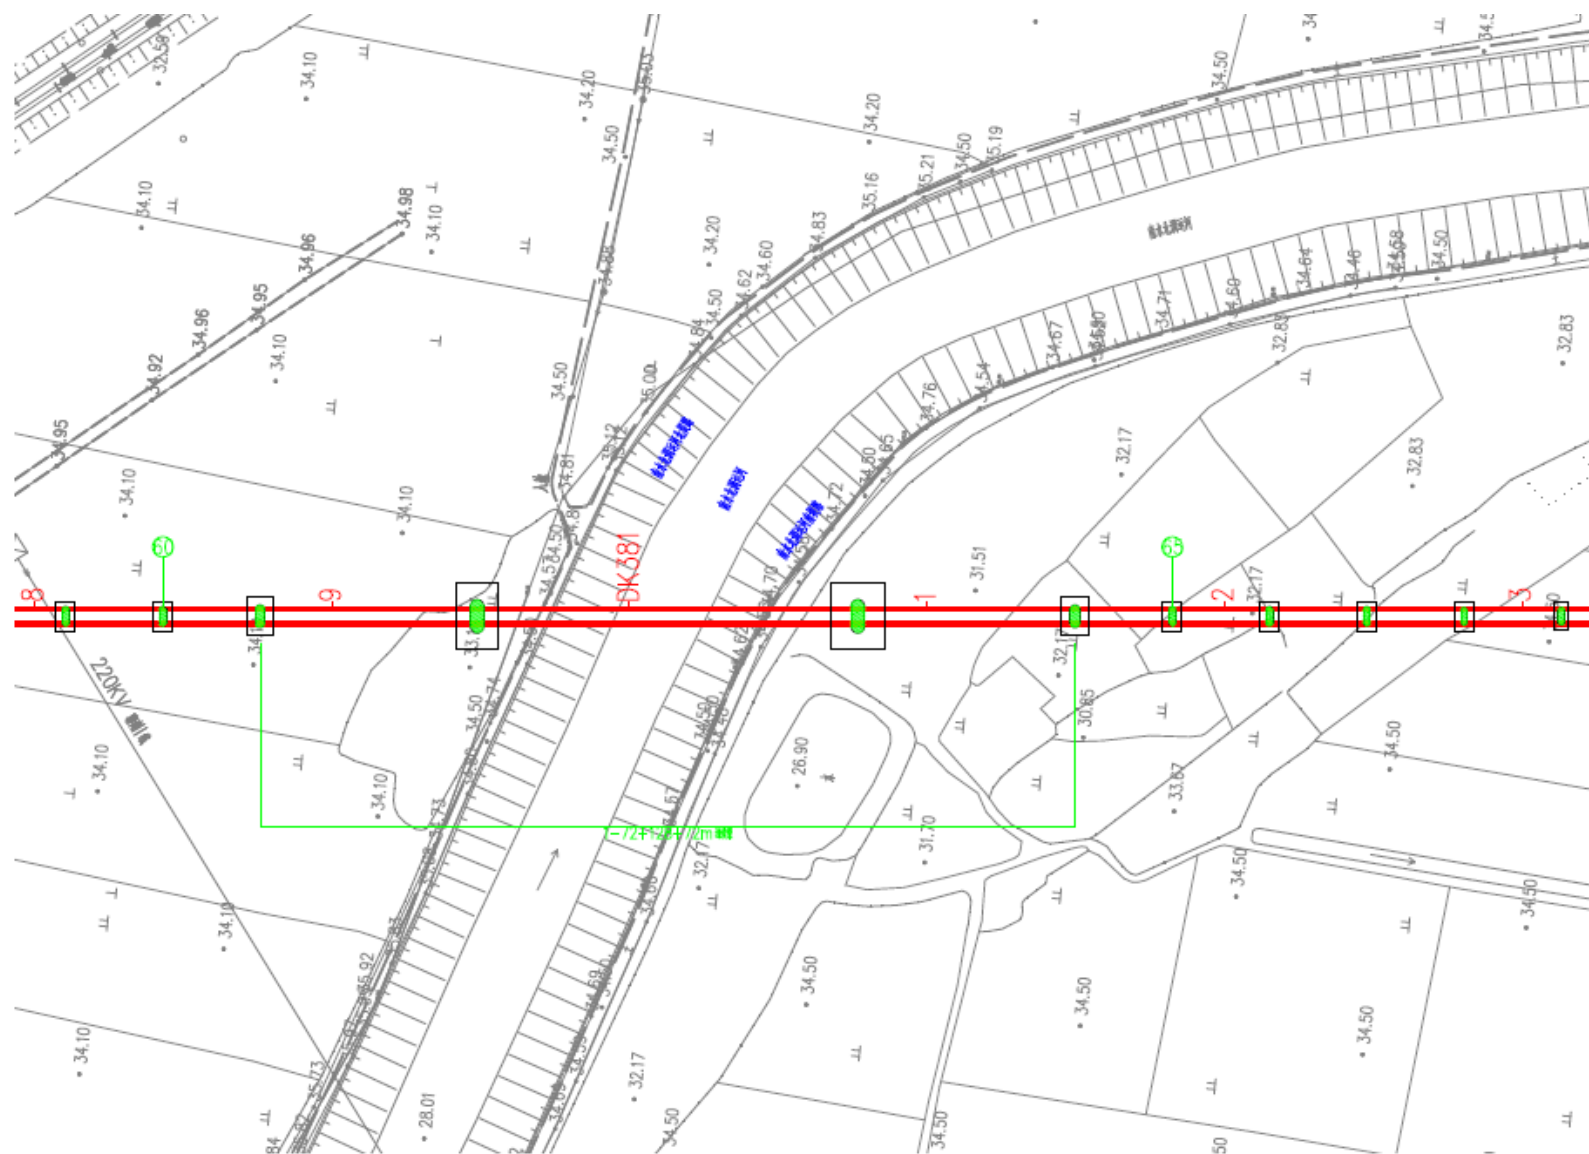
京雄商高铁会通河段桥梁平面布置图
